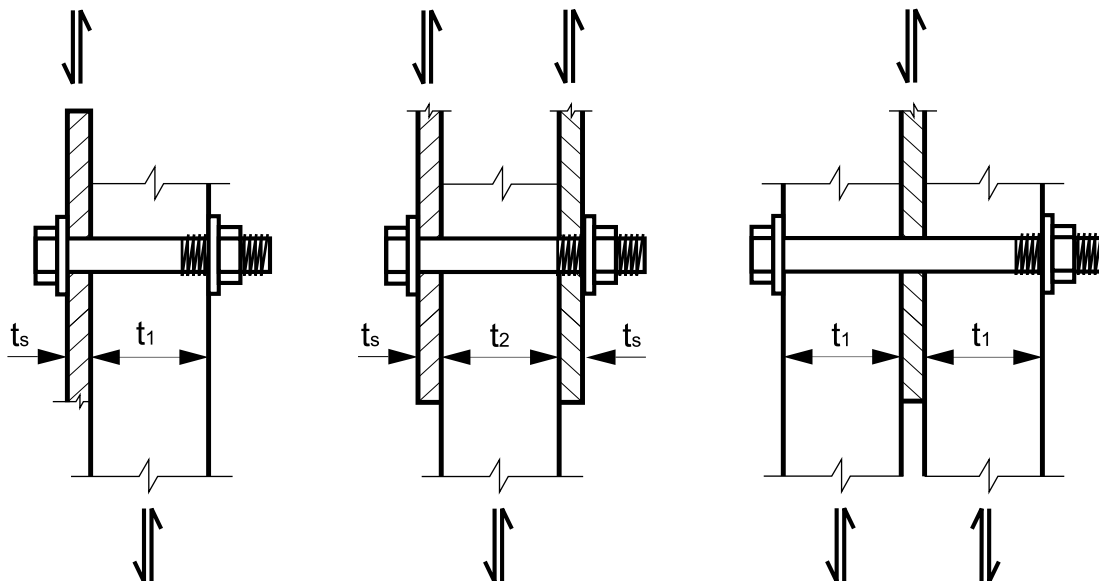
Configurações de ligações de elementos de madeira e aço com parafusos passantes
